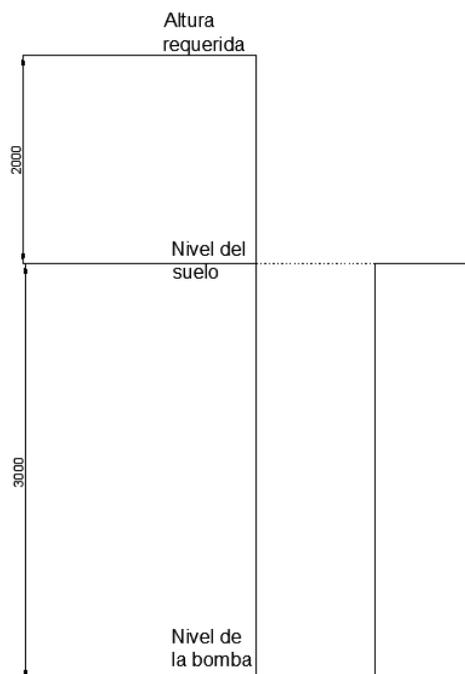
Altura que se requiere elevar la bomba. Fuente.
